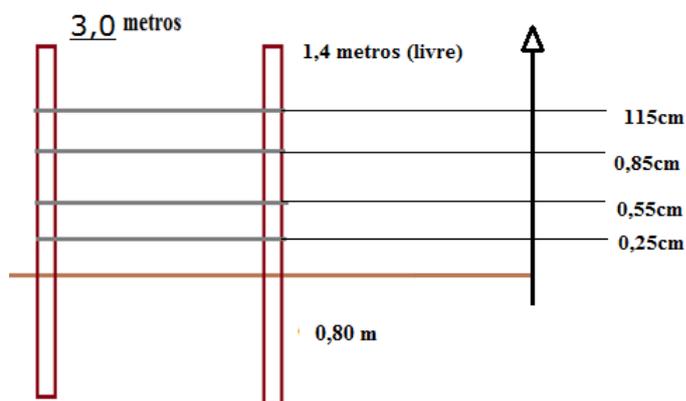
Esquema detalhado do espaçamento e dimensões da cerca.
